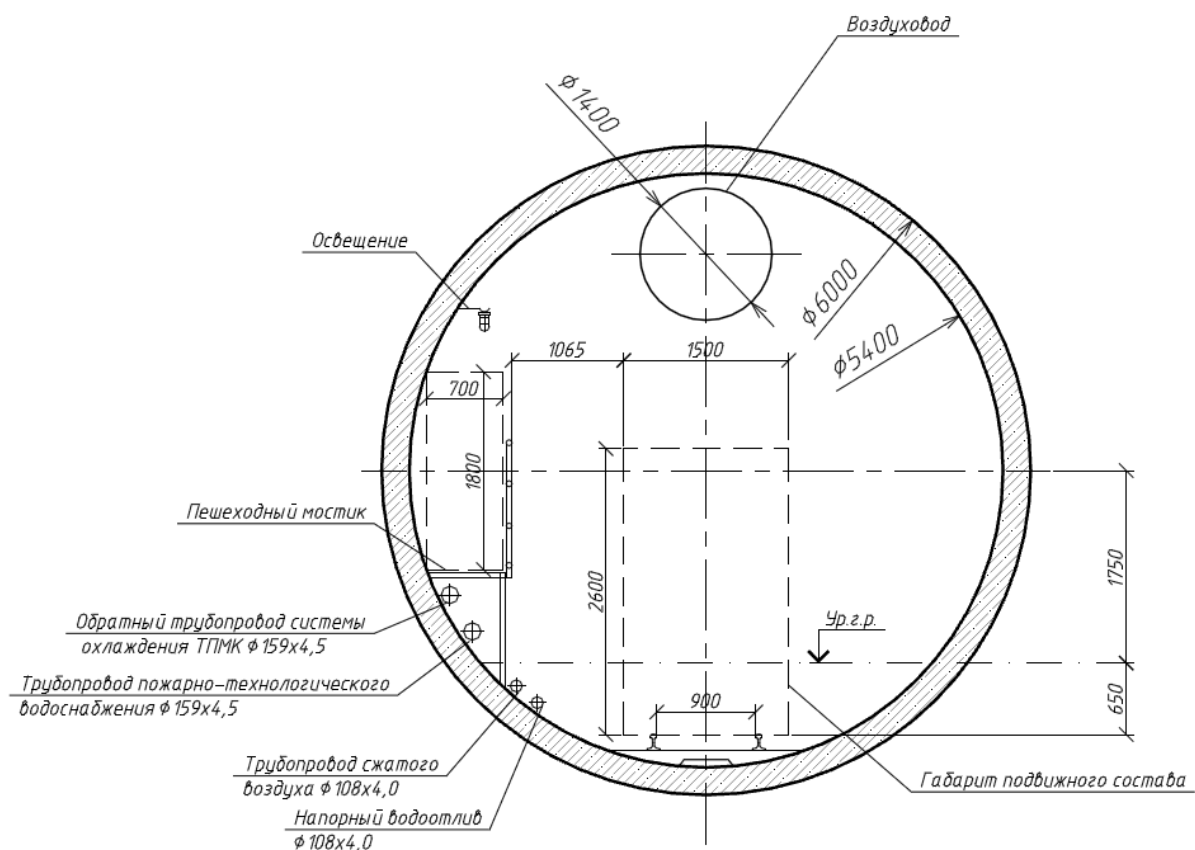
Строительные конструкции перегонного тоннеля
